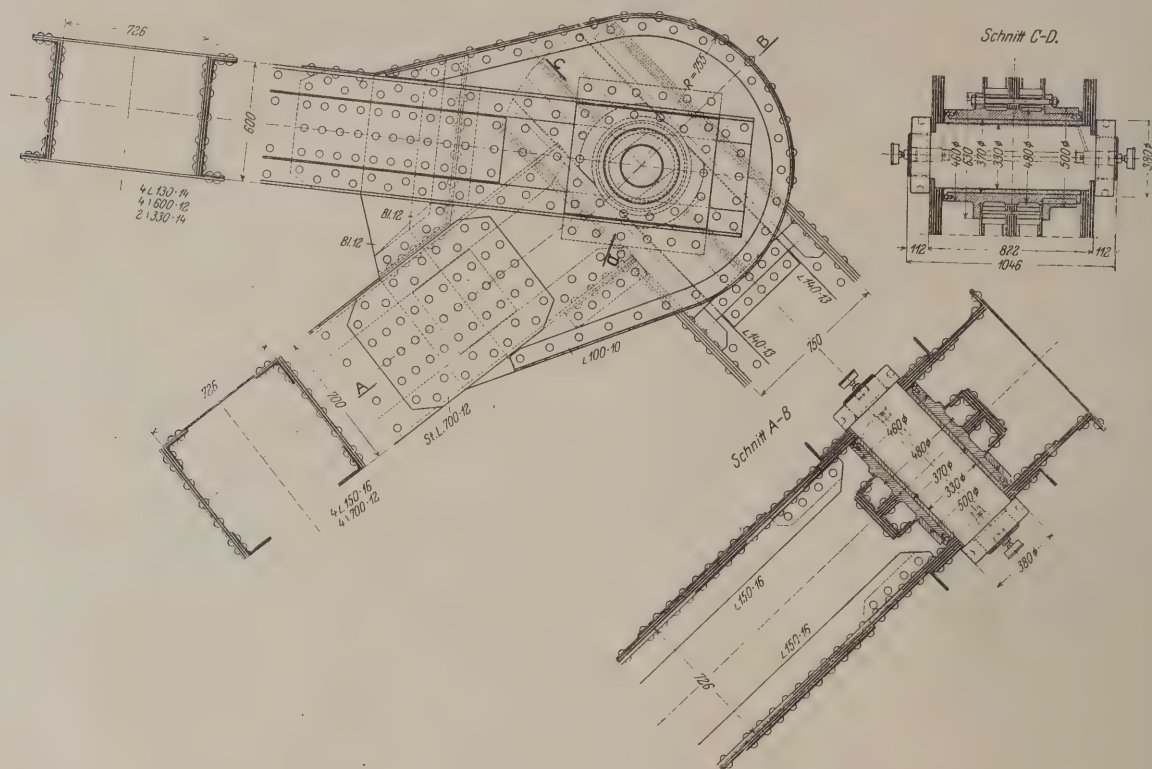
Verbindung der Gegengewichtsstrebe mit dem Wagebalken.
